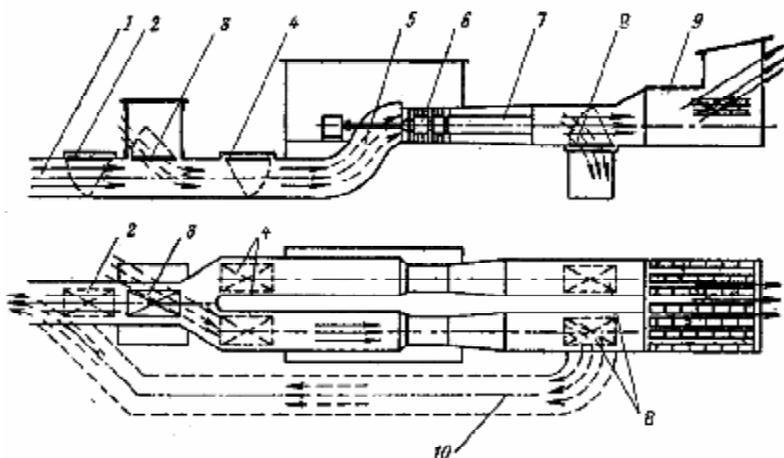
Схема вентиляторной установки с нереверсивным вентилятором ВОКД-3: 1 – подводящий канал; 2 –отсекающая лядя канала; 3 – лядя всасывающей будки; лядя переключения; 5 – утка; 6 – вентилятор; 7 – диффузор; 8 – лядя диффузоров; 9 – глушитель шума; 10 – обводной канал
